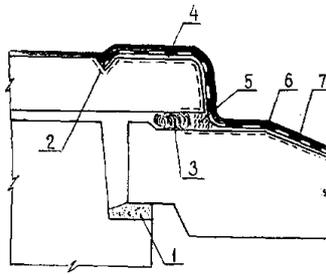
Конструктивная схема гидрозащиты типового узла плоской кровли с водосборными лотками-кессонами:
